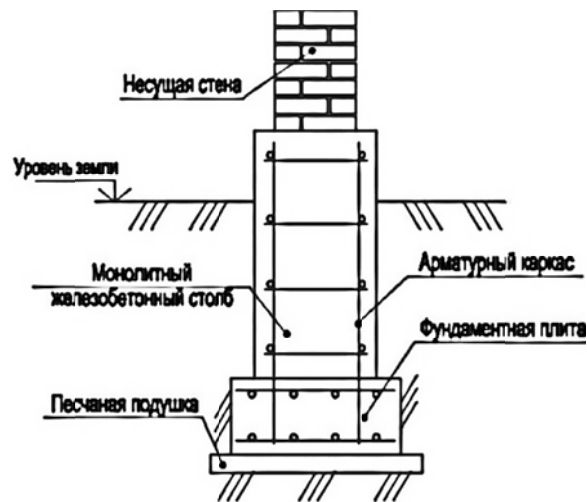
Монолитный железобетонный столбчатый фундамент под кирпичную стену
